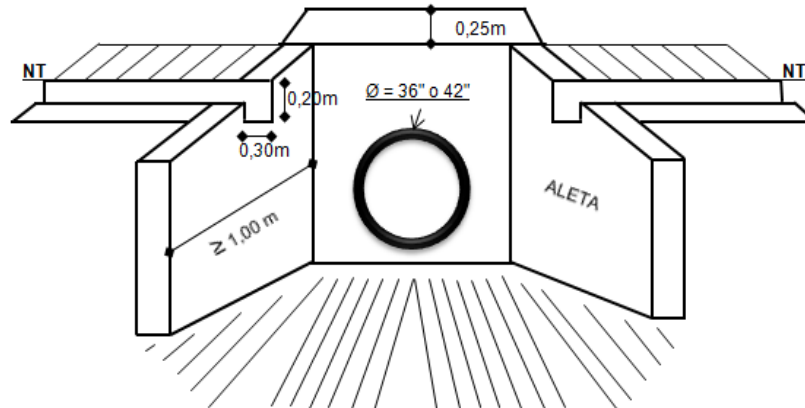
Tipo de la Obra de Drenaje – Descole
